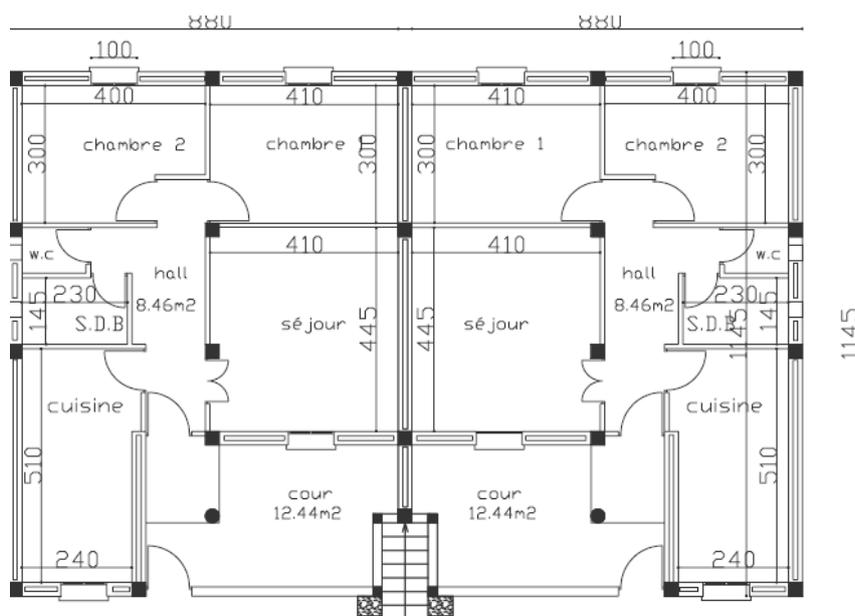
plan type des logements réalisés, plan du RDC (02 F3)
